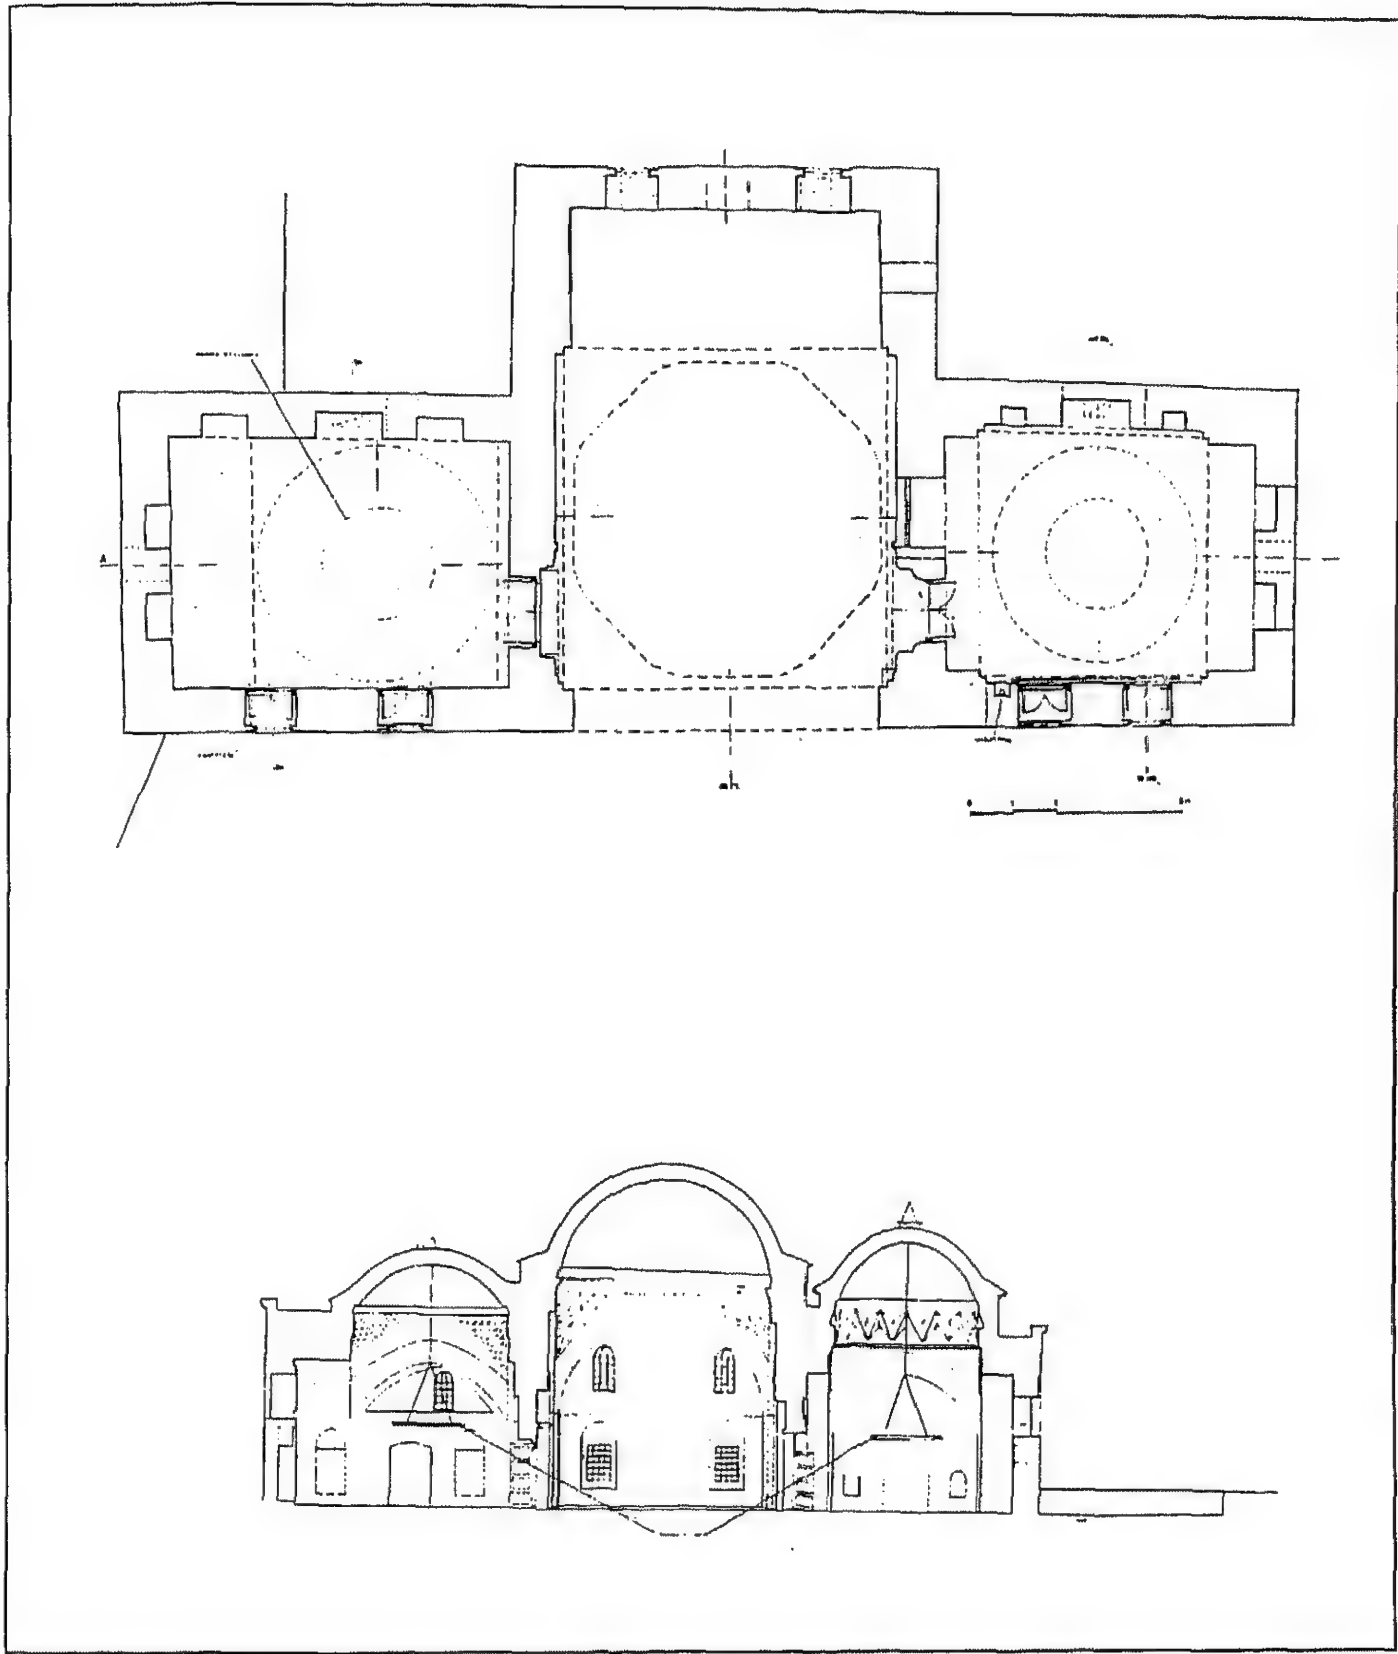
مسقط أفقي وواجهة چشمه قبطان حاجي حسين باشا بإستانبول (عن :
